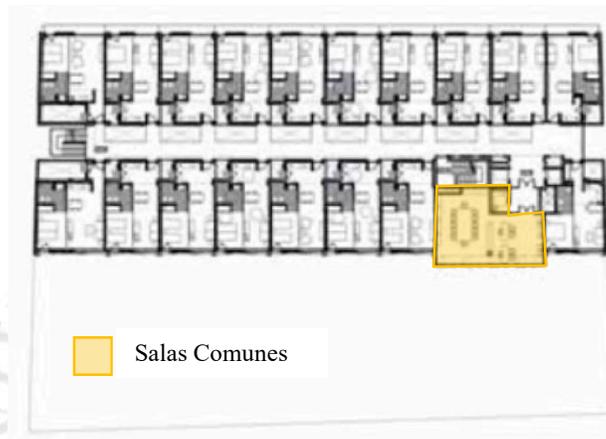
Planta Típica, tercera a sexta. Tipo de viviendas y salas comunes
